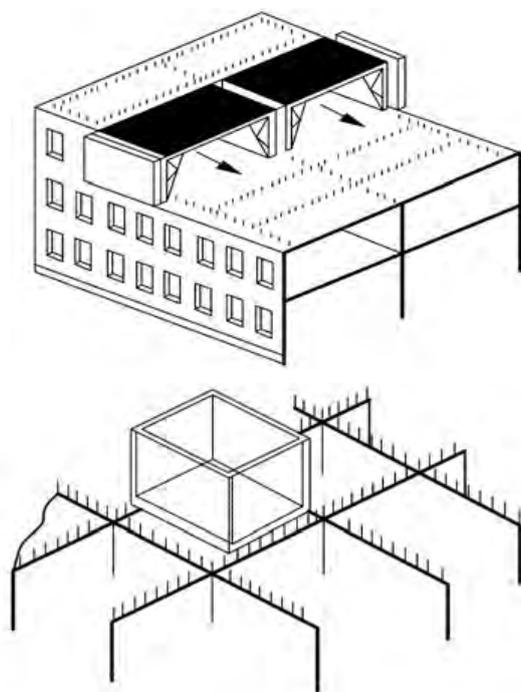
Возведение монолитного здания в объемной переставной опалубке путем ее перемещения
